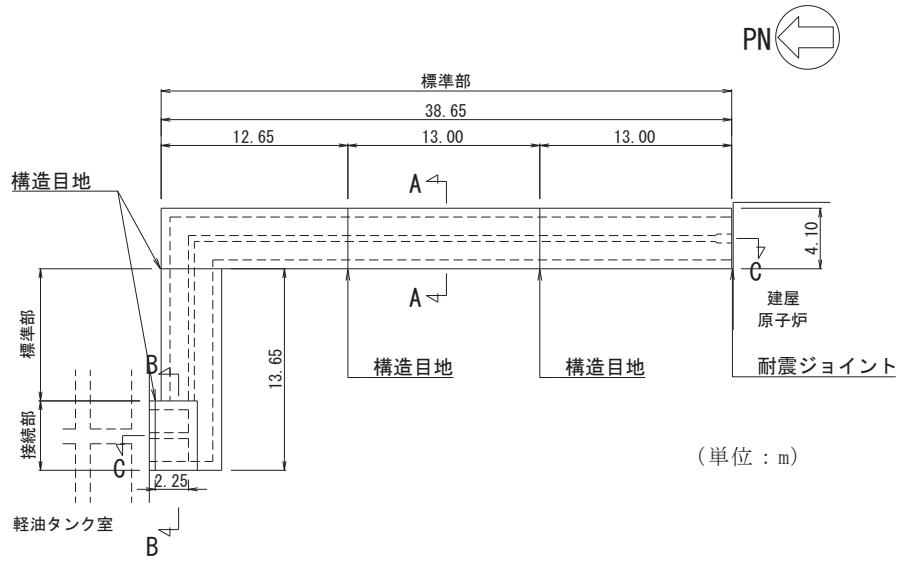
軽油タンク連絡ダクト平面図 (詳細)
